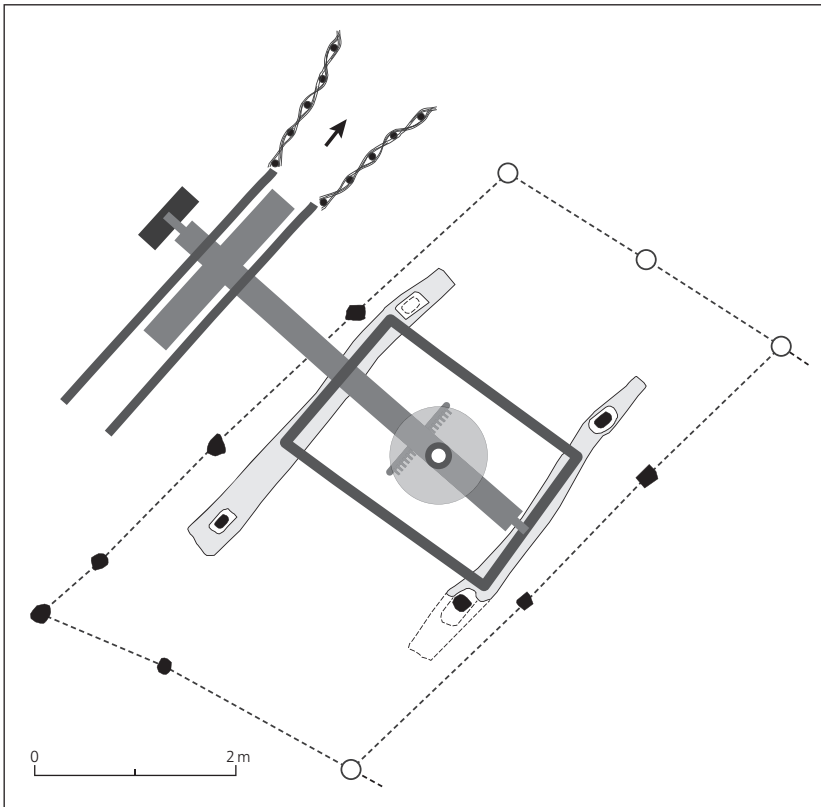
Grundrissrekonstruktion der Wassermühle Stelle 2 mit schematisierter Mühlentechnik und einem Gerinne nach dem Vorbild der Elfgener Mühle, Maßstab 1:75.
